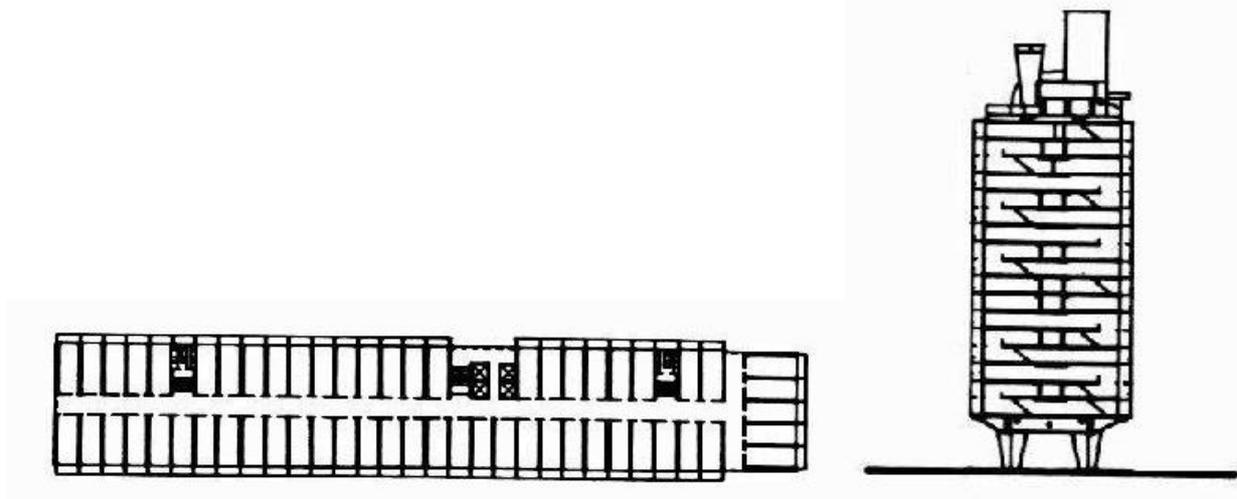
Planta tipo e corte transversal da Unidade de Habitação
